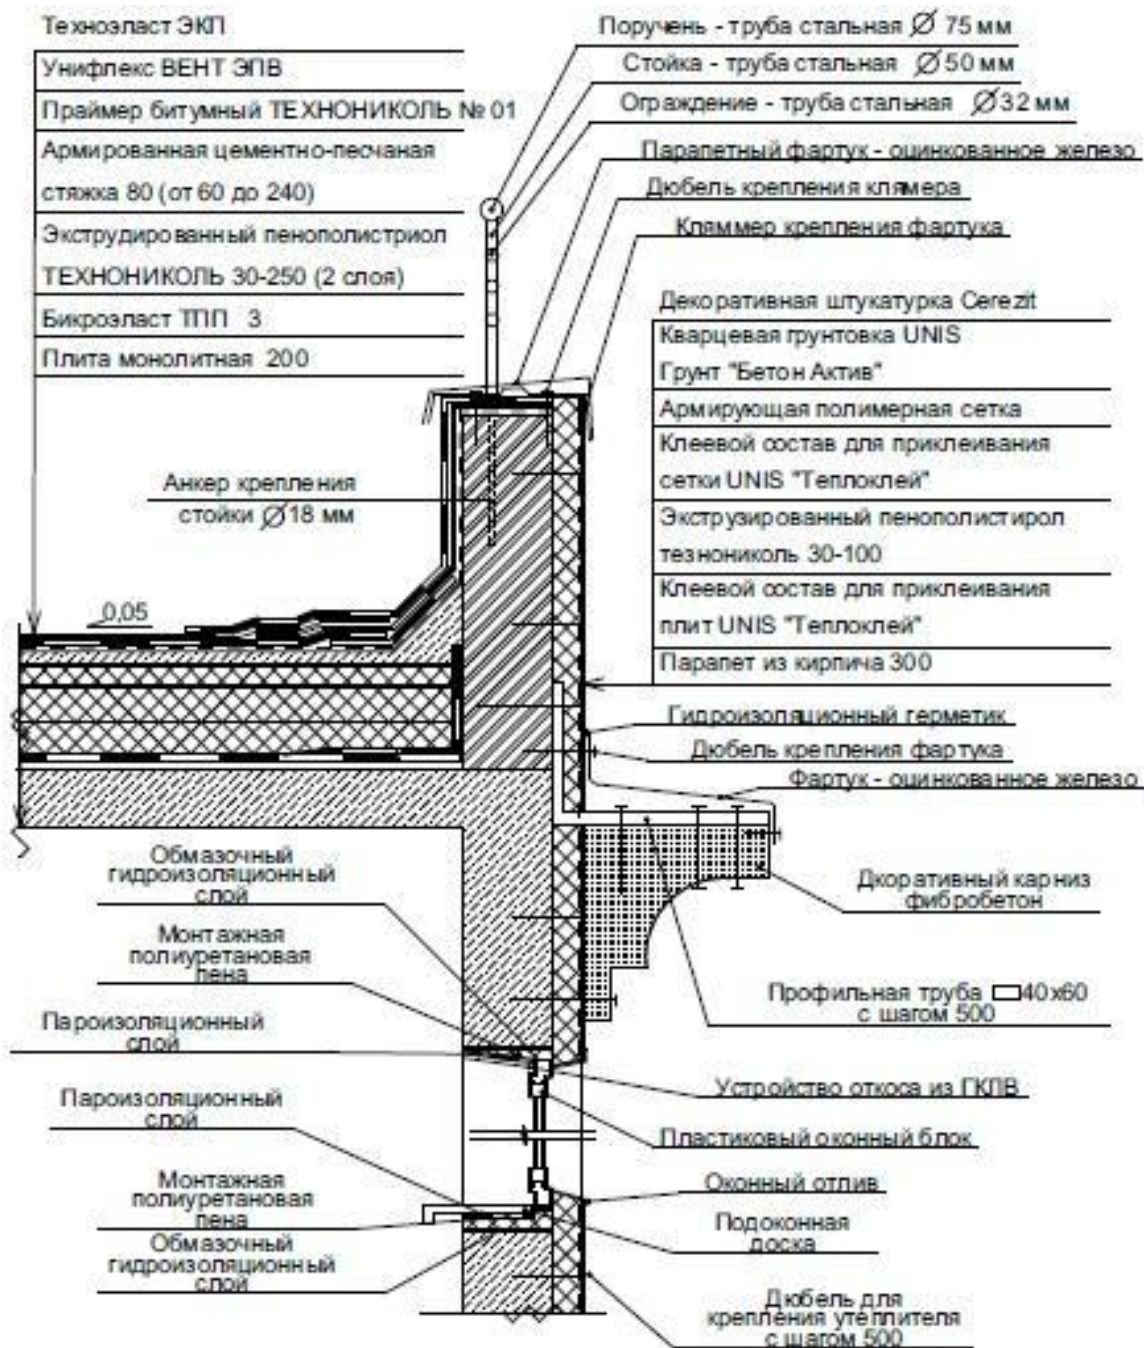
Конструктивное решение покрытия жилого дома из монолитного железобетона
